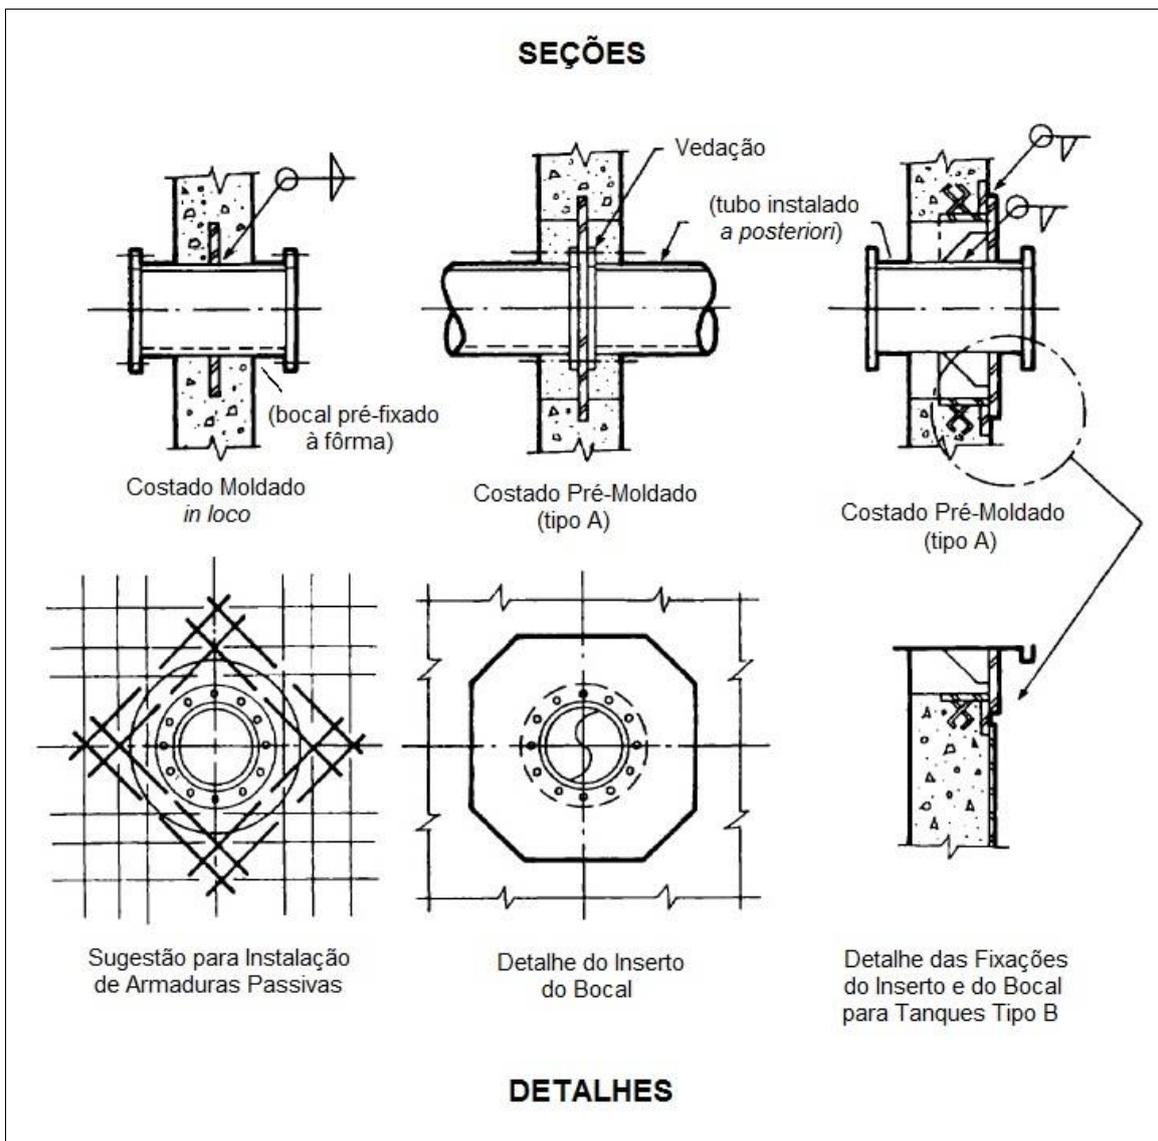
Exemplos de bocais e aberturas de costado de tanques de concreto [adaptado de FIB (1978)].
